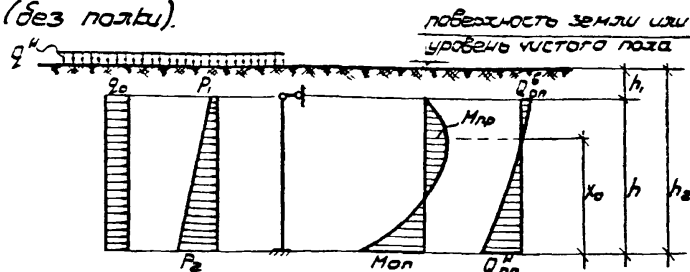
Расчетная схема вертикальной стеновой панели, нагрузки и расчетные усилия (M и Q)
